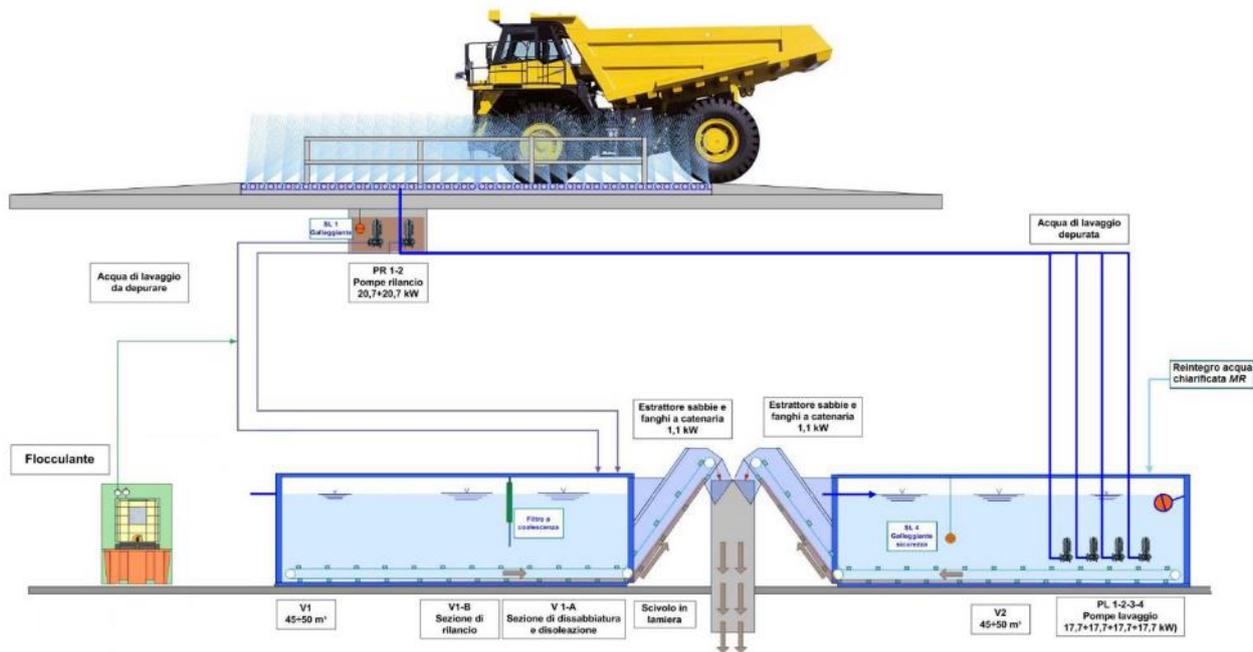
SCHEMA TIPO IMPIANTO DI LAVAGGIO A BASSA PRESSIONE CON RICIRCOLO ACQUA
